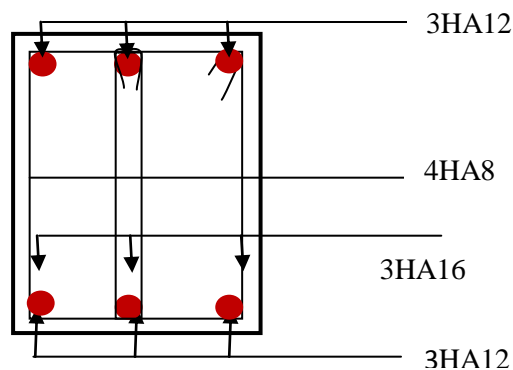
Ferrailage en travée d'une poutre secondaire.
